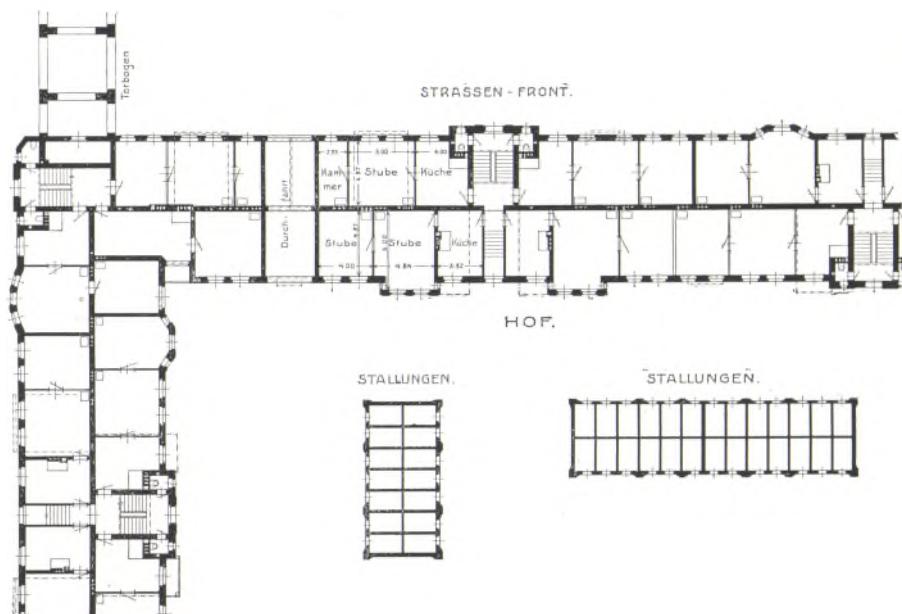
Kolonie Nickischschacht. Ausschnitt aus einem Wohnhäuserblock. Grundriß.
